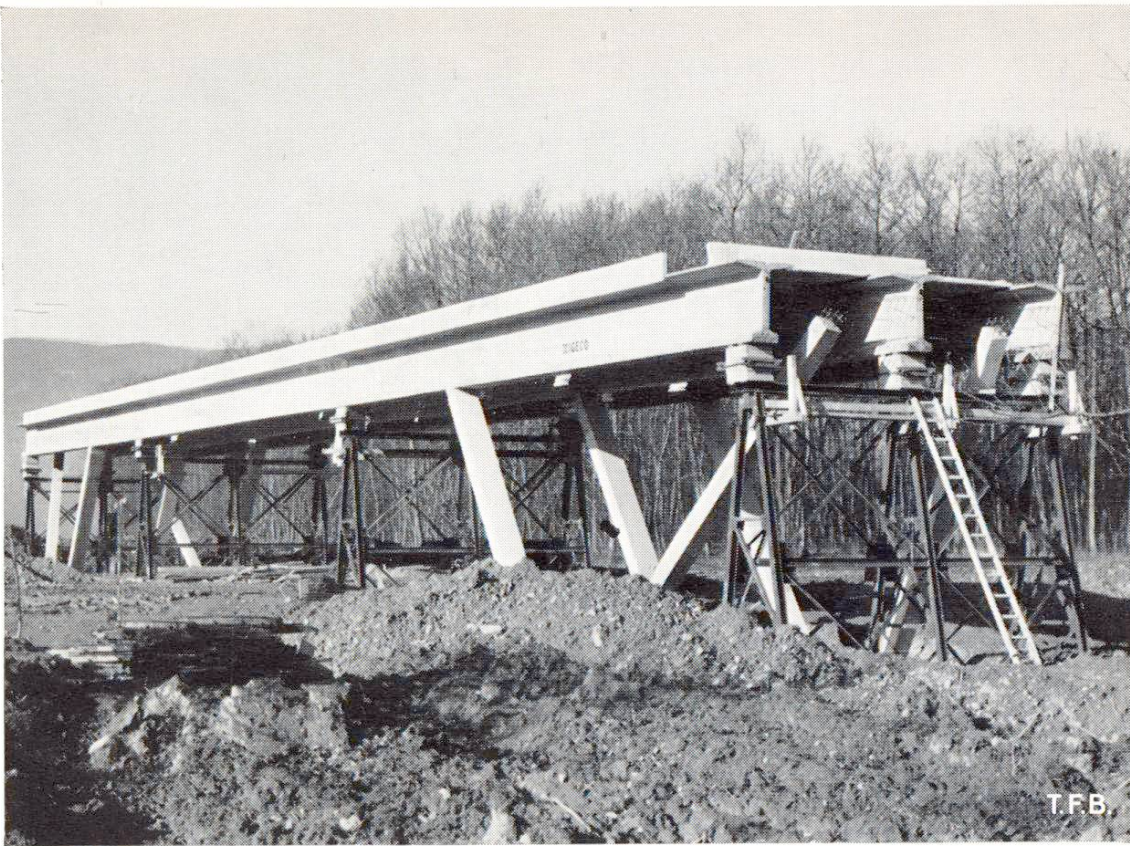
Montage d'un des ponts de la figure 4. Les trois poutres continues sont en trois parties, préfabriquées et précontraintes en usine. La photo est prise au moment où les trois parties de chaque poutre sont placées bout à bout sur les chevalets de montage, et sur le point d'être précontraintes par un câble longitudinal, de telle sorte qu'elles formeront ensuite des poutres continues de 48 m de long. La largeur du pont est de 6 m. On remarquera aussi les plaques préfabriquées formant coffrages inférieur et latéral de la dalle chaussée qui sera bétonnée sur place. Cette photo montre en outre d'une façon frappante que le montage d'un tel pont peut se faire quel que soit l'avancement des travaux de l'autoroute ou de la route à franchir.
